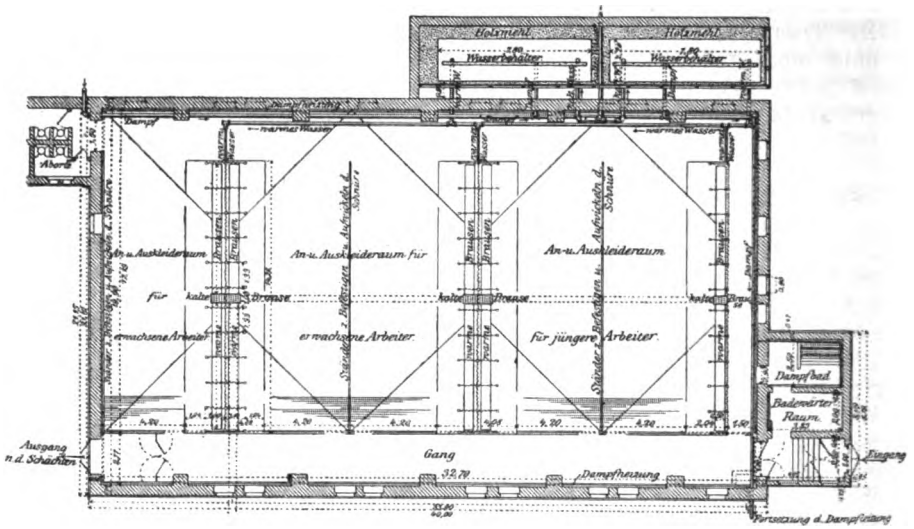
Brausebad auf Grube Dudweiler. Grundriss.
